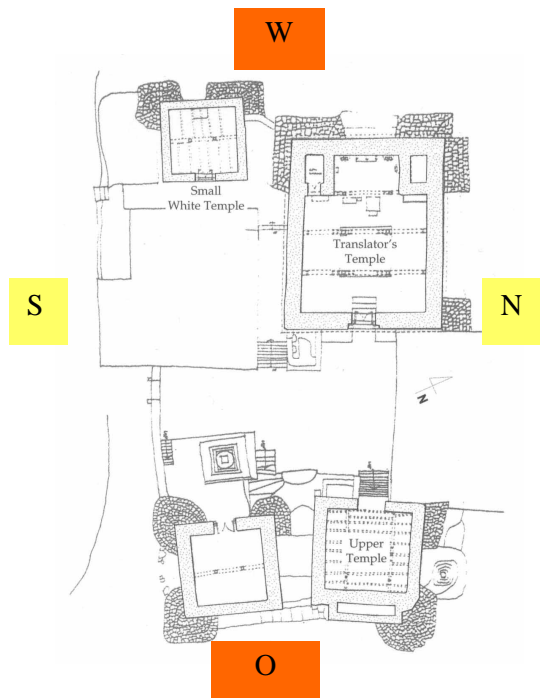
Nako, Grundriss der Tempelanlage
